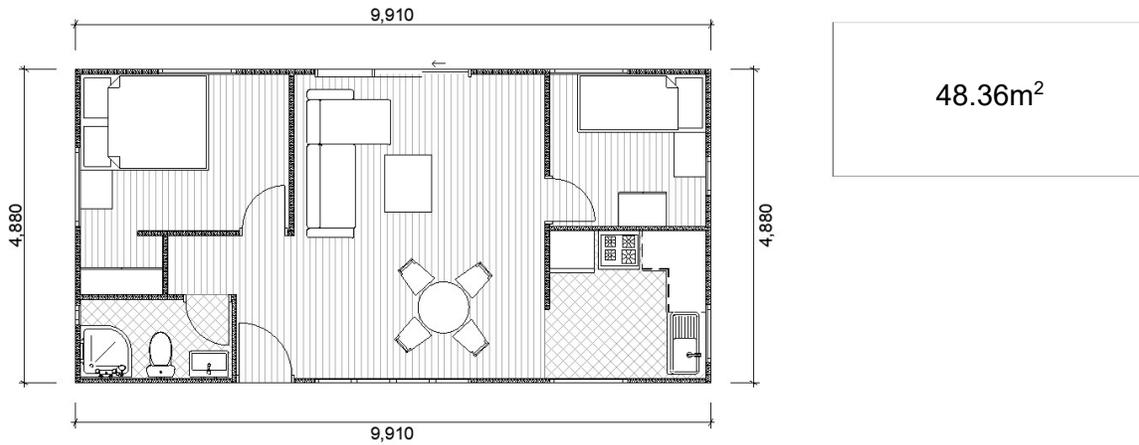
Planta casa básica. Fuente: Elaboración propia.
